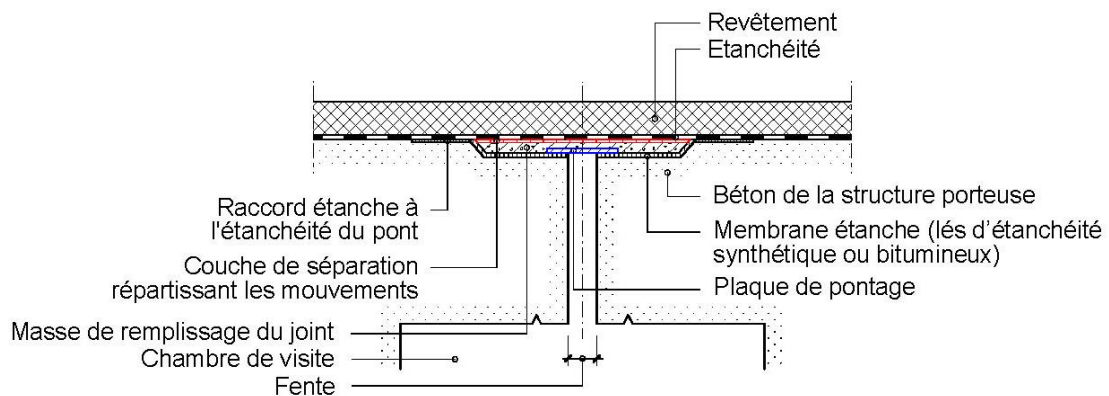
Coupe schématique d'un joint à membrane, avec membrane interrompue à la hauteur du joint.
